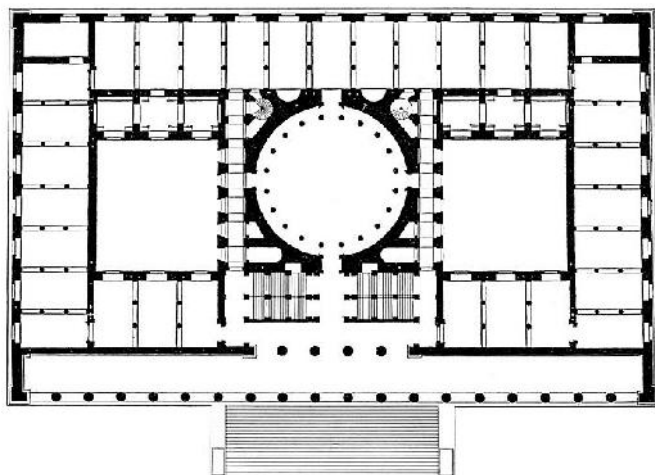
Karl Friedrich Schinkel, der: La Nueva Guardia, 1817, fotografía CNM. Altes Museum, 1828, izq: planta; abajo, fachada, fotos CNM, Berlín.
